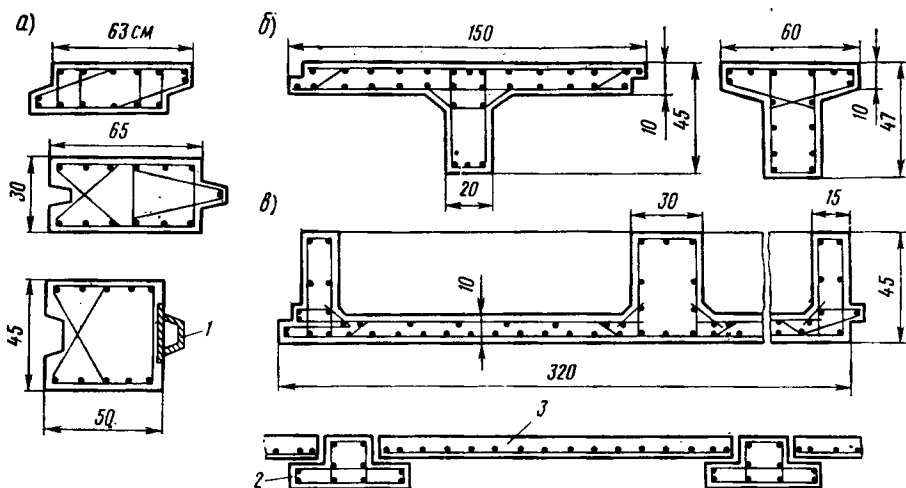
Поперечные сечения железобетонных шпунтин:
